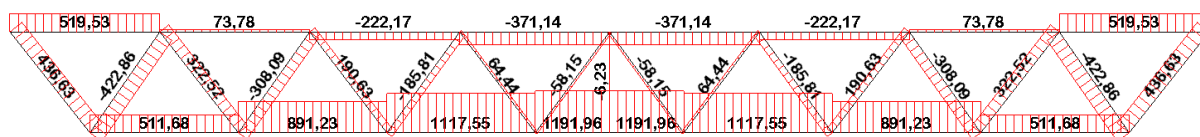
Эпюры усилий в элементах фермы от постоянной нагрузки
